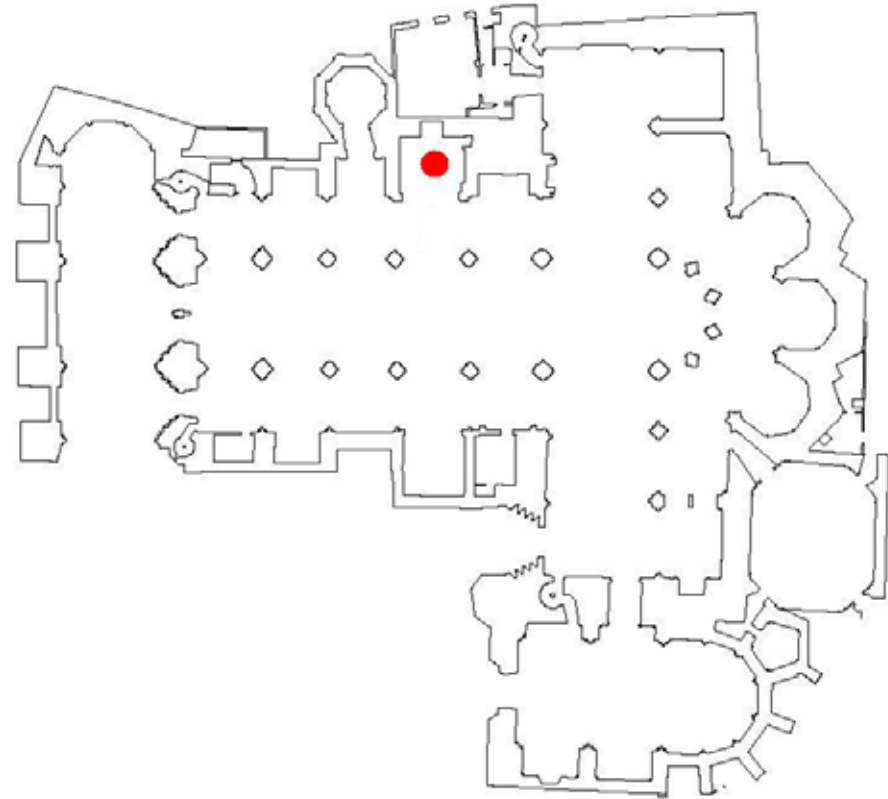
Vitoria-Gasteiz. Planta de la Catedral Santa María
